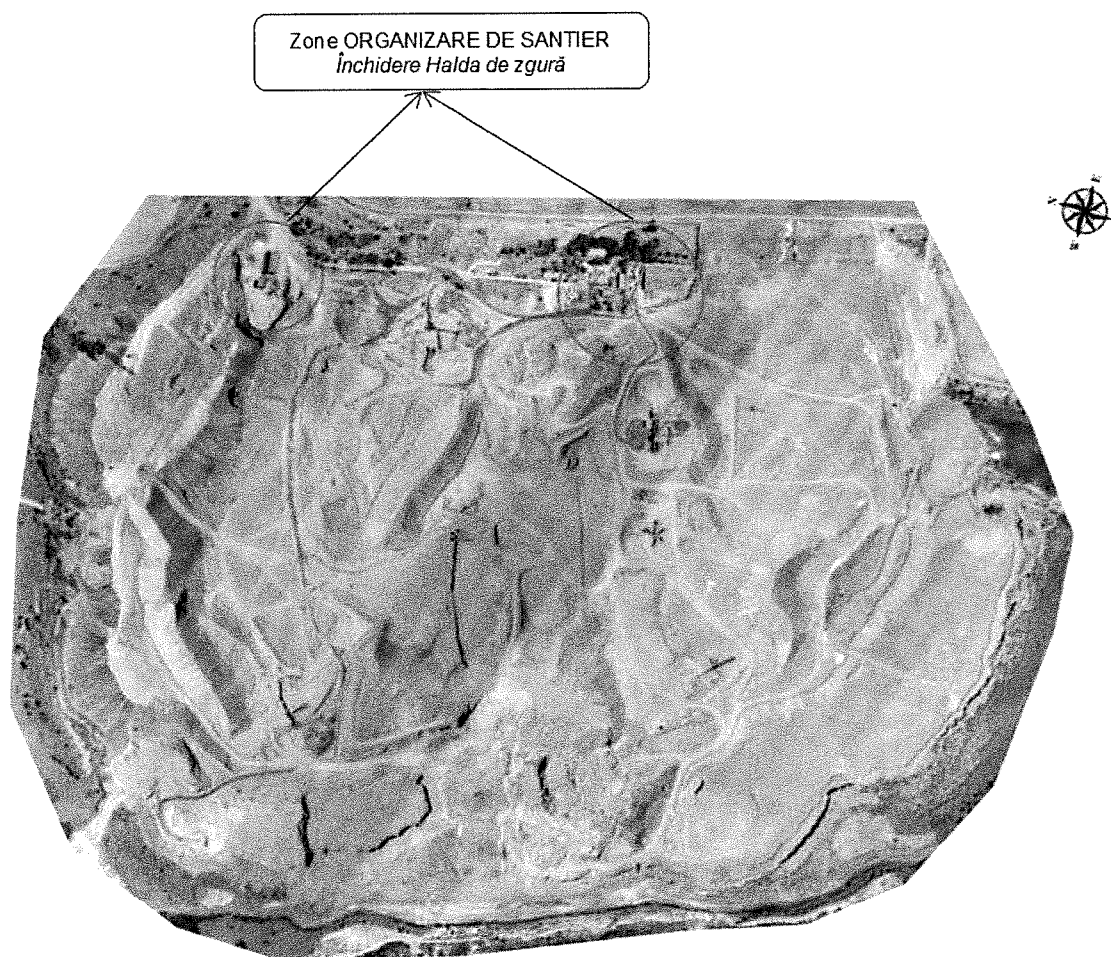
Poziționare organizare de șantier pentru proiectul de închidere haldă
